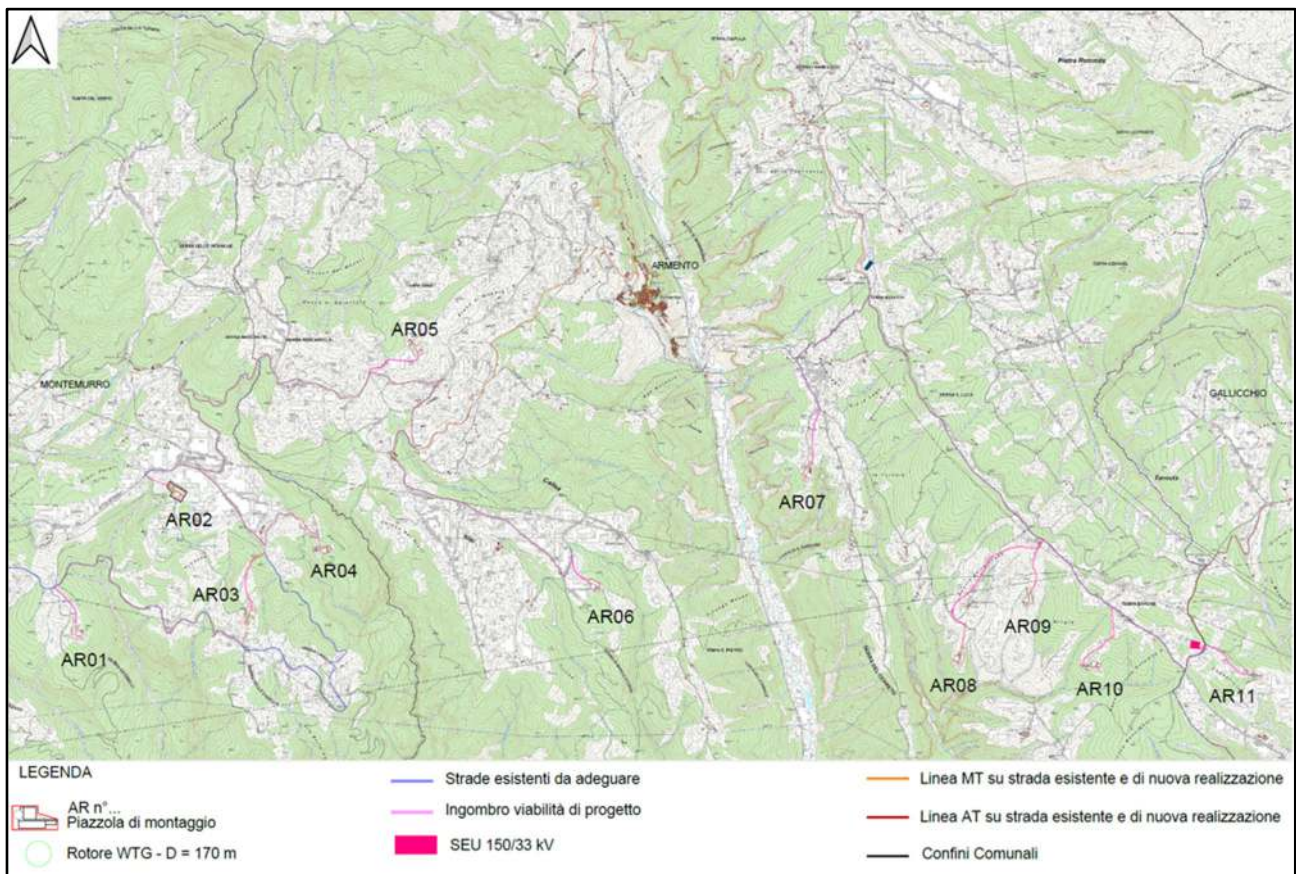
Layout d'impianto con viabilità di progetto e linee elettriche MT su CTR
